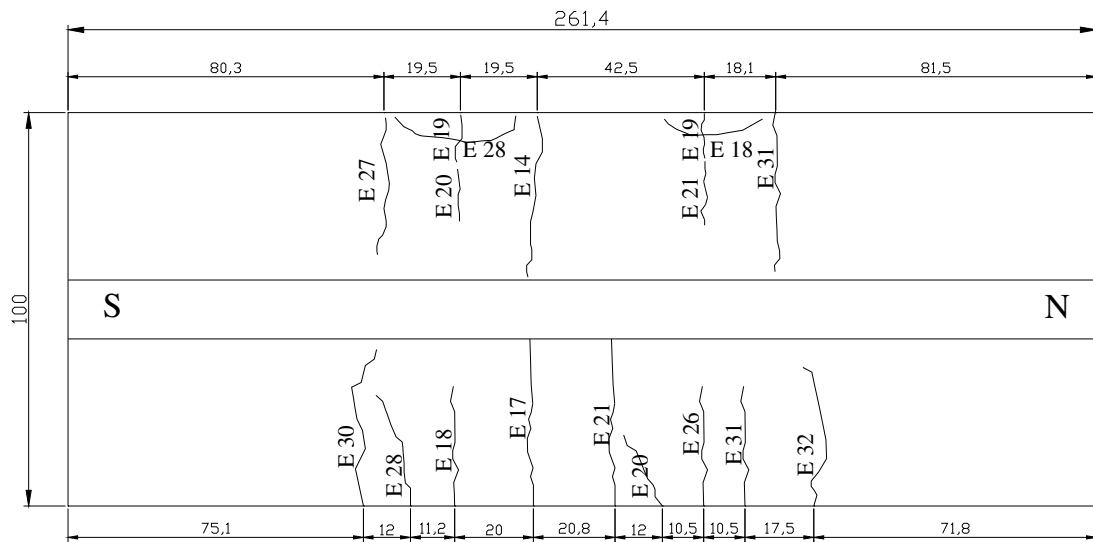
Fissuras do modelo 1A (face inferior da laje) – medidas em cm.
